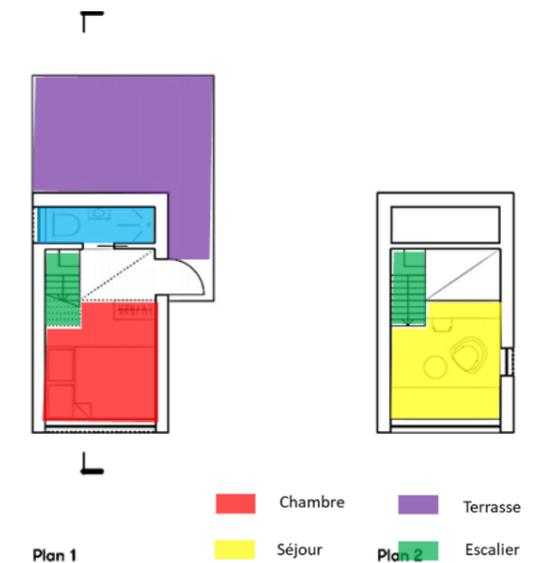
Plan du chalet Ivy, source : Archdaily.com
